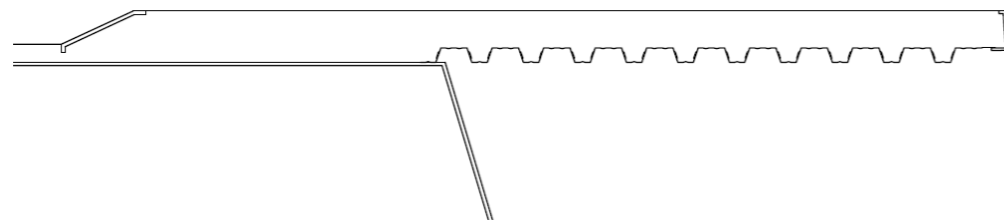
Tramo de losa con chapa grecada. Fuente: Elaboración Propia (AutoCAD)
